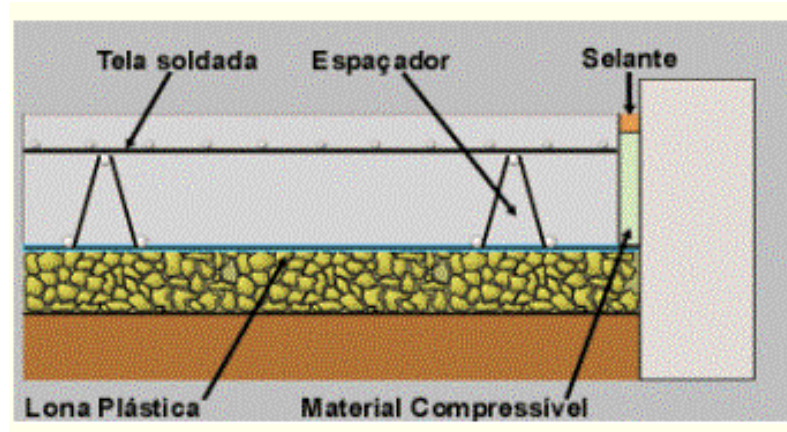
Detalhes de uma junta de Isolação ou expansão.
